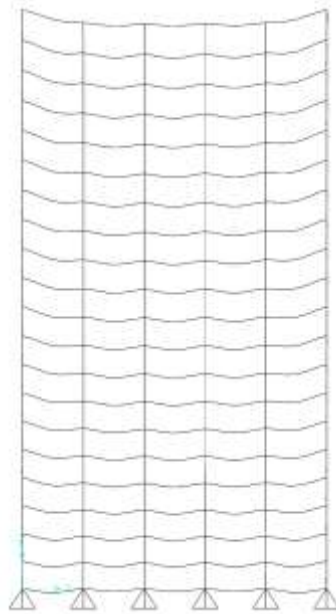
Deformadas – Corte Longitudinal passando pela Viga V7 – Caso 1 – Sem o vento
